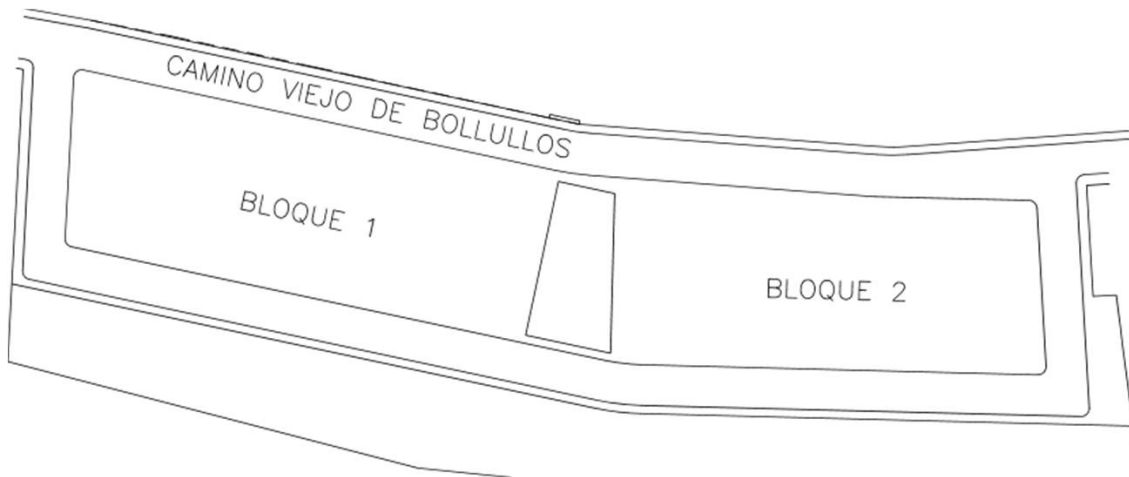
Planimetría del proyecto a analizar (Solís-Guzmán, 2011)
